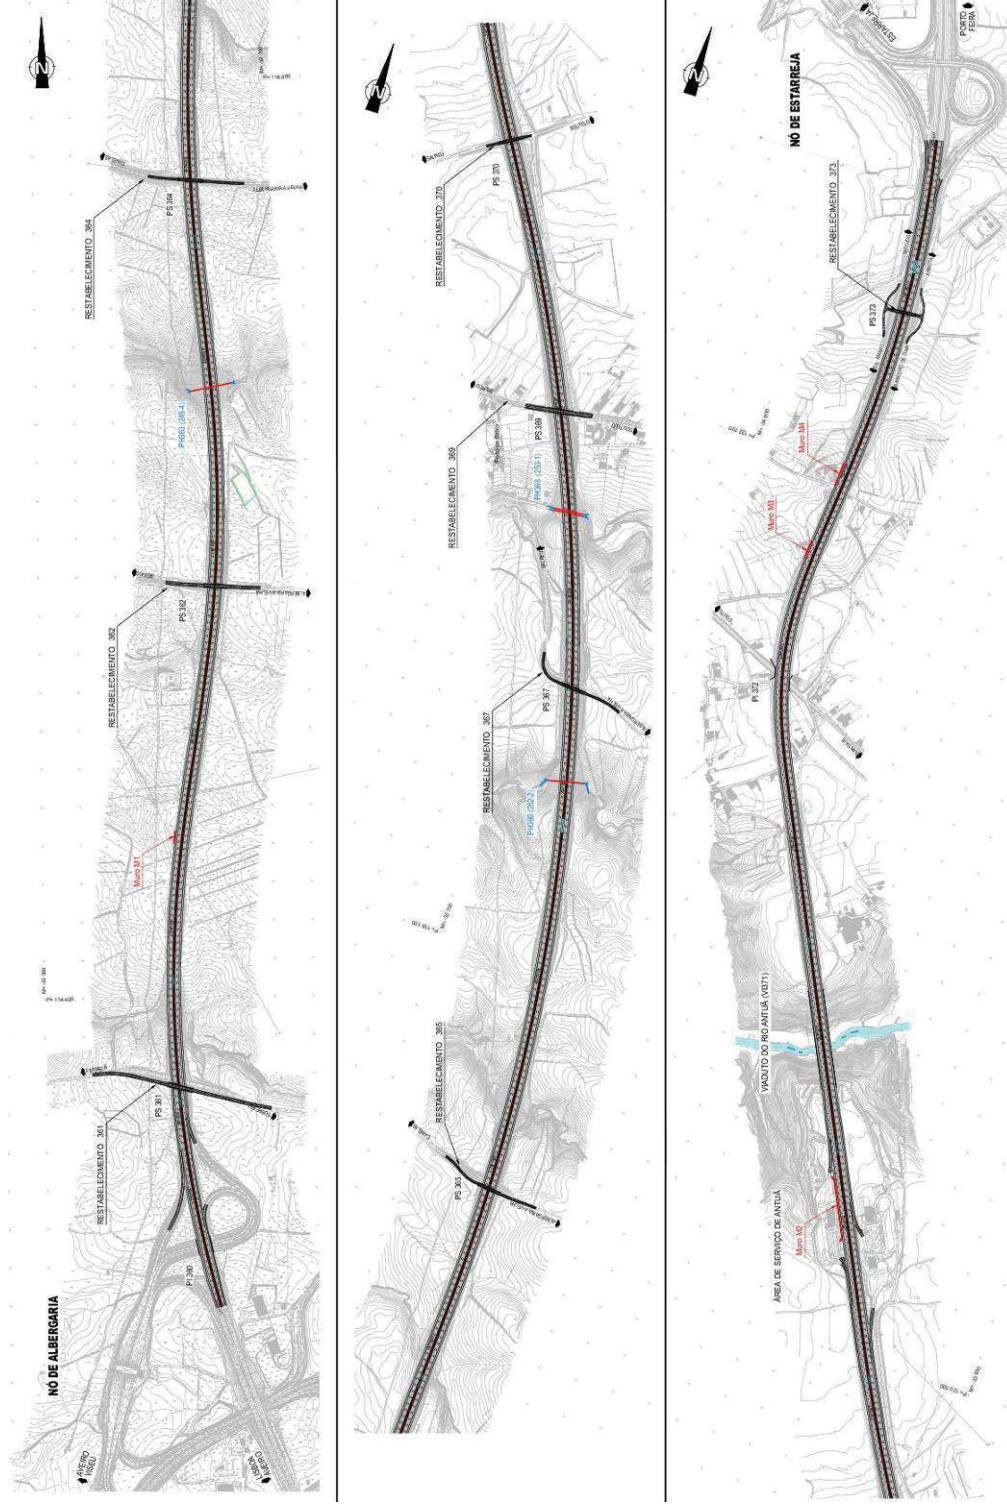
Planta Geral de localização das Obras de Contenção
